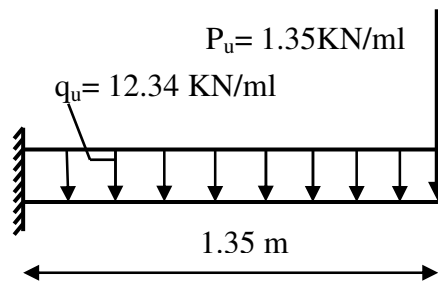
Schéma statique de la dalle pleine à l'ELU du balcon.
